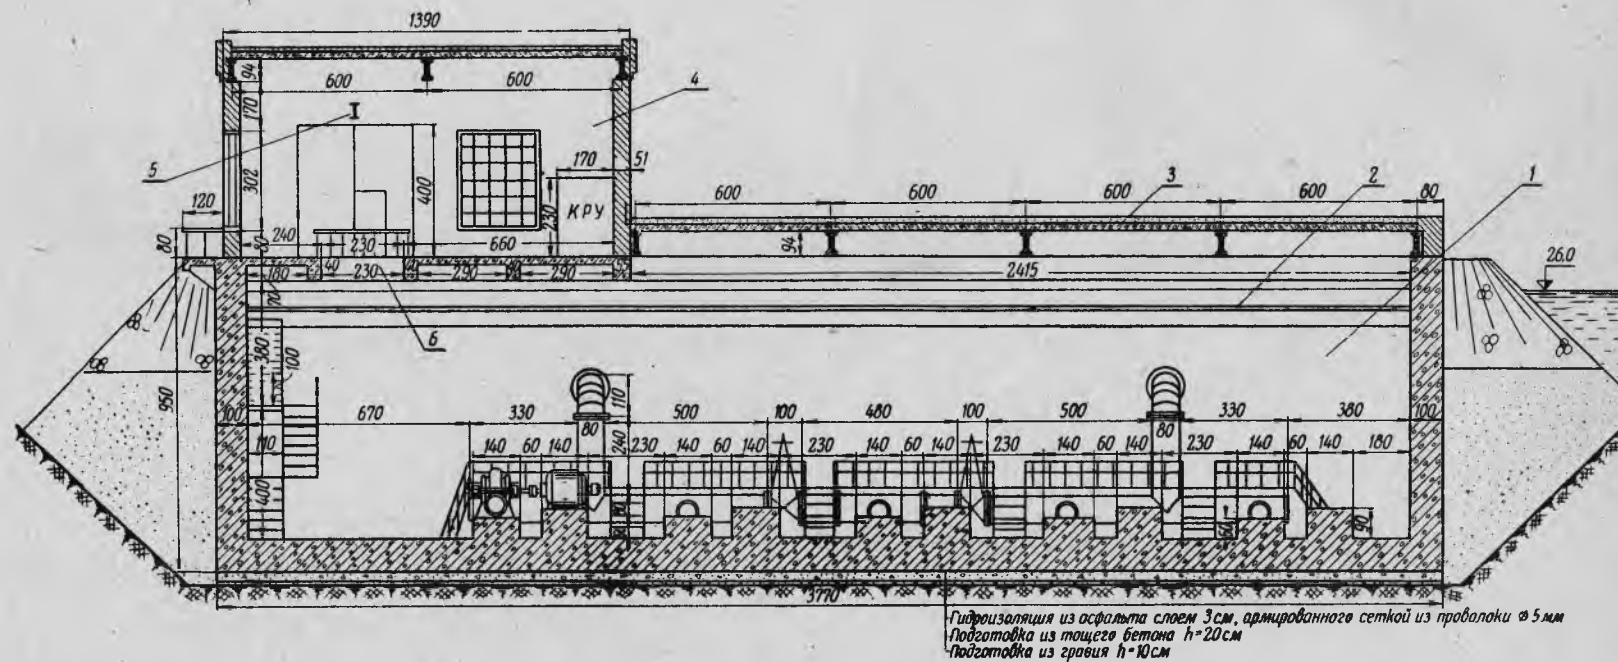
Продольный разрез здания насосной станции шахтно-камерного типа с надземной частью только над монтажной площадкой:
